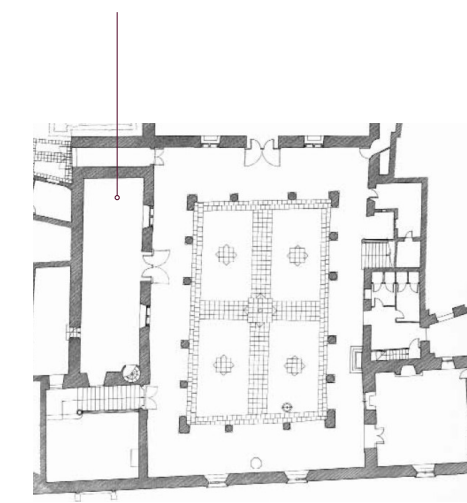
Esquema de planta baja del Palacio de Fuensalida. Toledo, S. XV.
